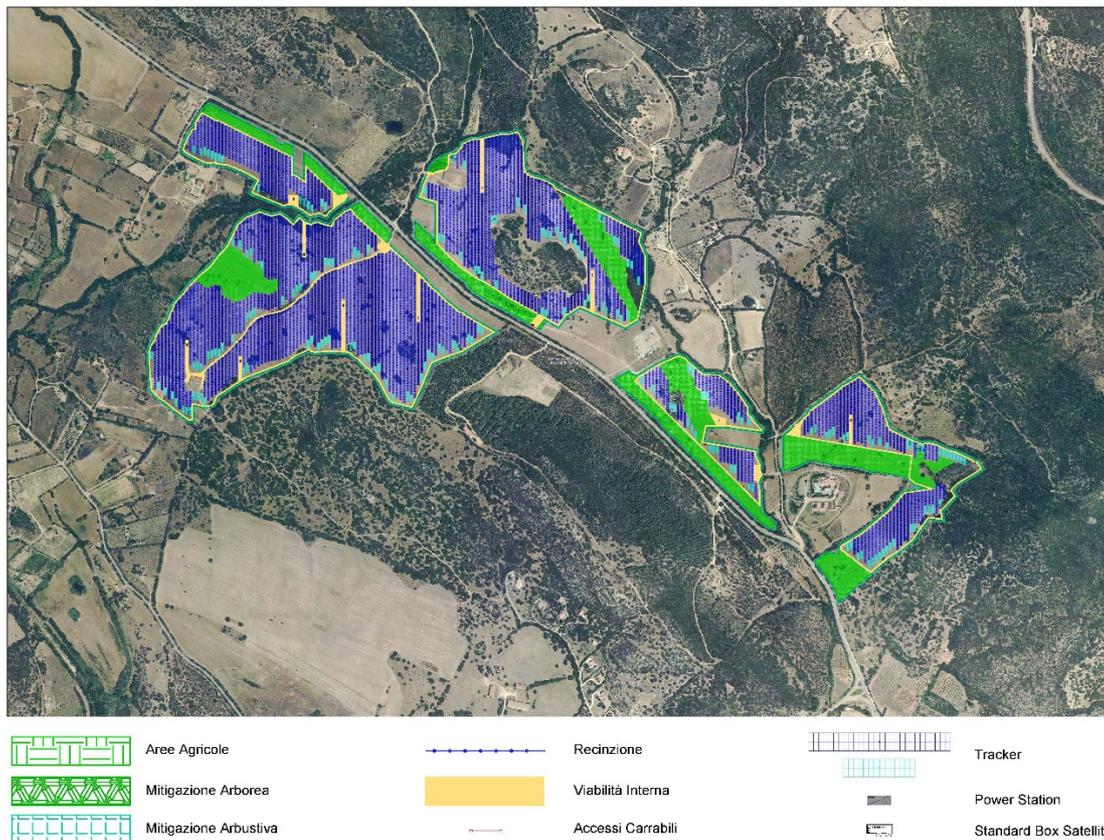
Layout dell’area d’impianto ricadente sul territorio di Teulada (SU)
